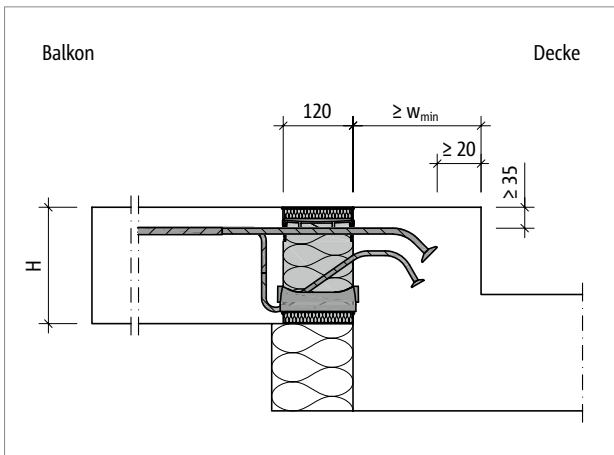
Schöck Isokorb® XT Typ KL-O: Balkon mit Höhenversatz nach oben und Außendämmung
